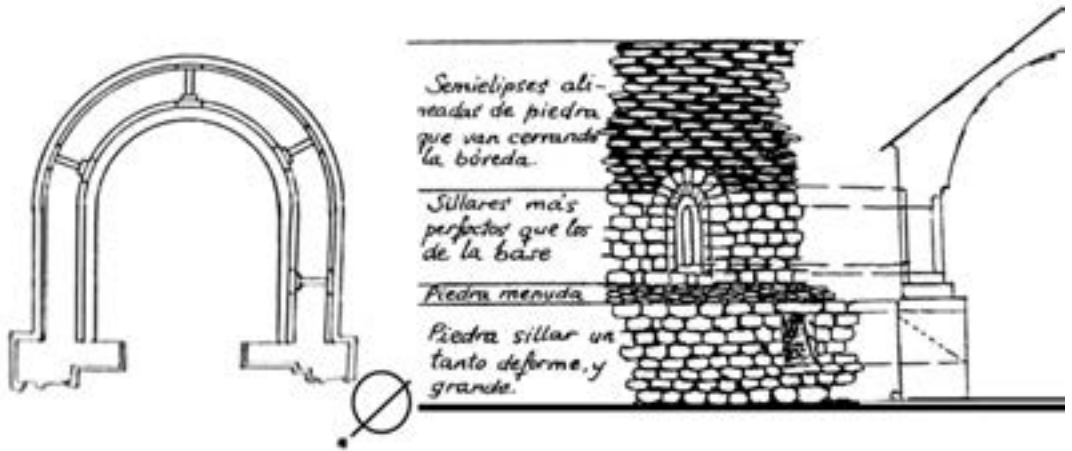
Detalh dera planta orientada, auçat parcial e seccion de Sant Blas de Les [4]
